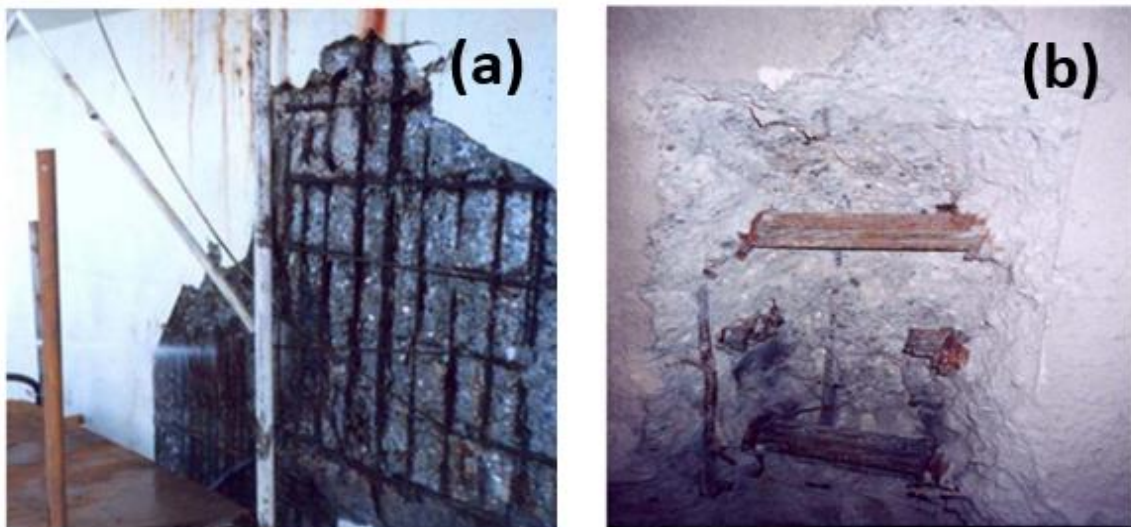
(a) Corrosion sévère des armatures passives dans une poutre-caisson précontrainte, et (b) Début de la corrosion des armatures actives dans une poutre en caisson précontrainte (Moradi-Marani et al., 2010).
